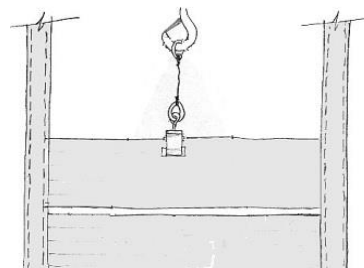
IMAGEN DE WEB MONTANDO DE MANERA SIMILAR ENTRE PERFILES METÁLICOS
